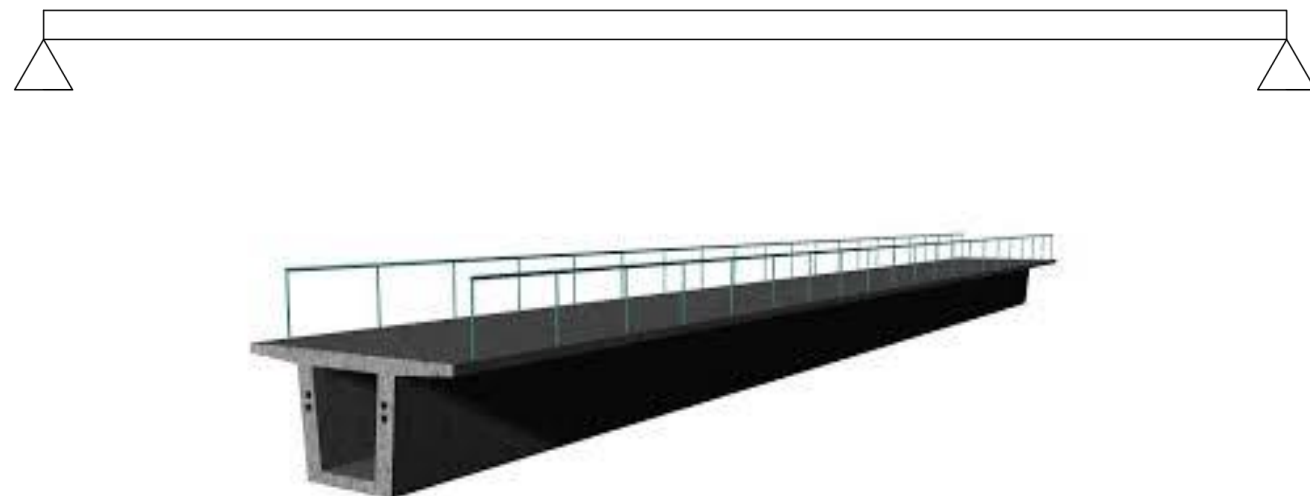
Ejemplo puente de vigas de hormigón (FUENTE: Google imágenes).
